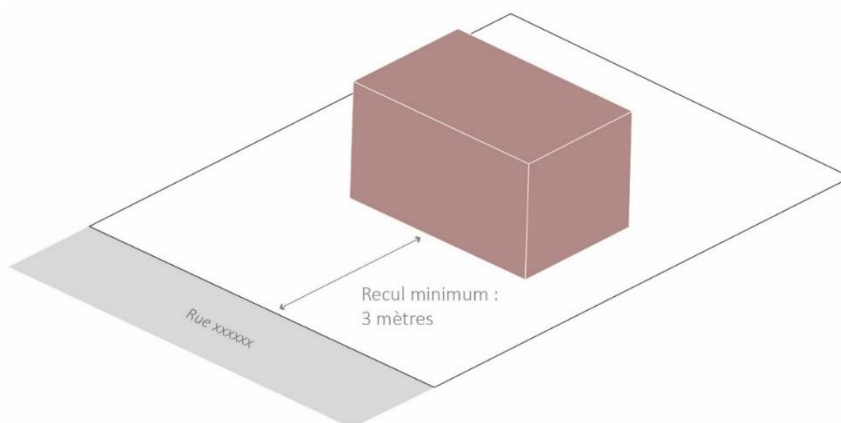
\_ Implantation des nouvelles constructions par rapport à l'alignement
